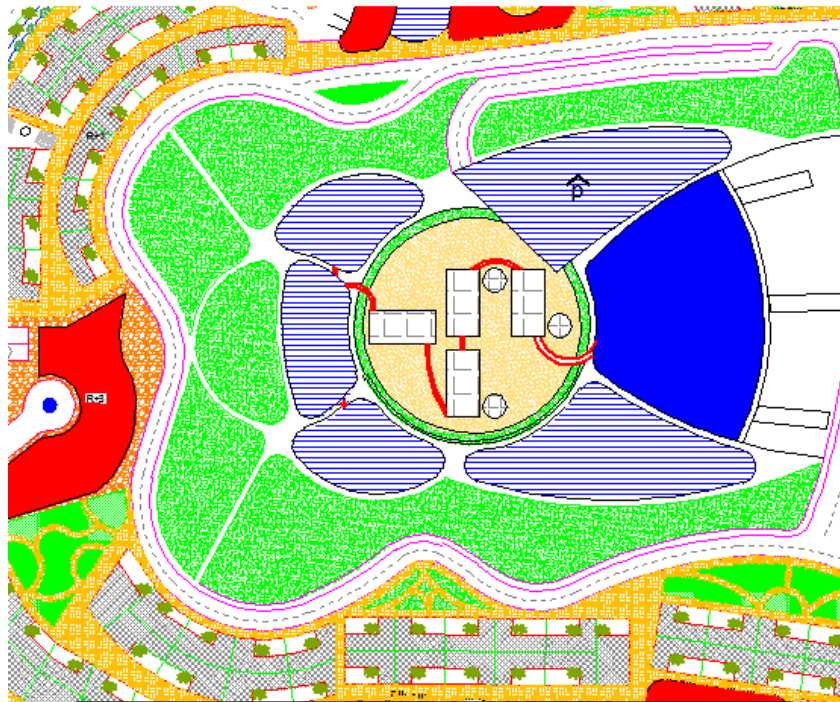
Champ photovoltaïque sur le plan d'aménagement
